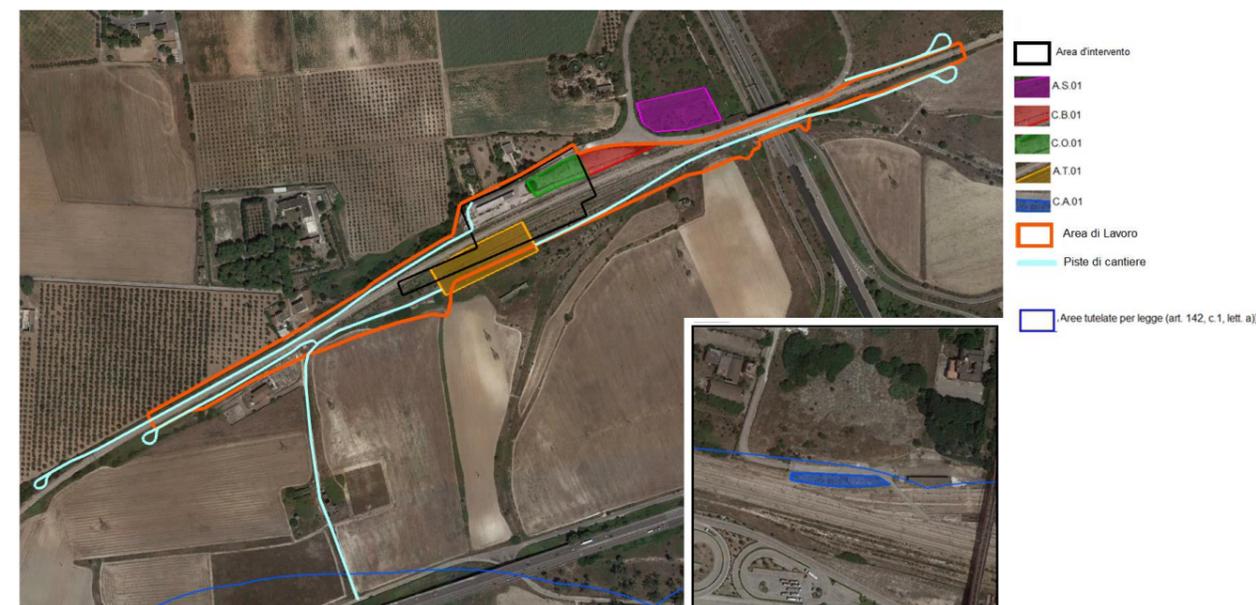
Localizzazione dell'area d'intervento e delle aree di cantiere rispetto il vincolo
